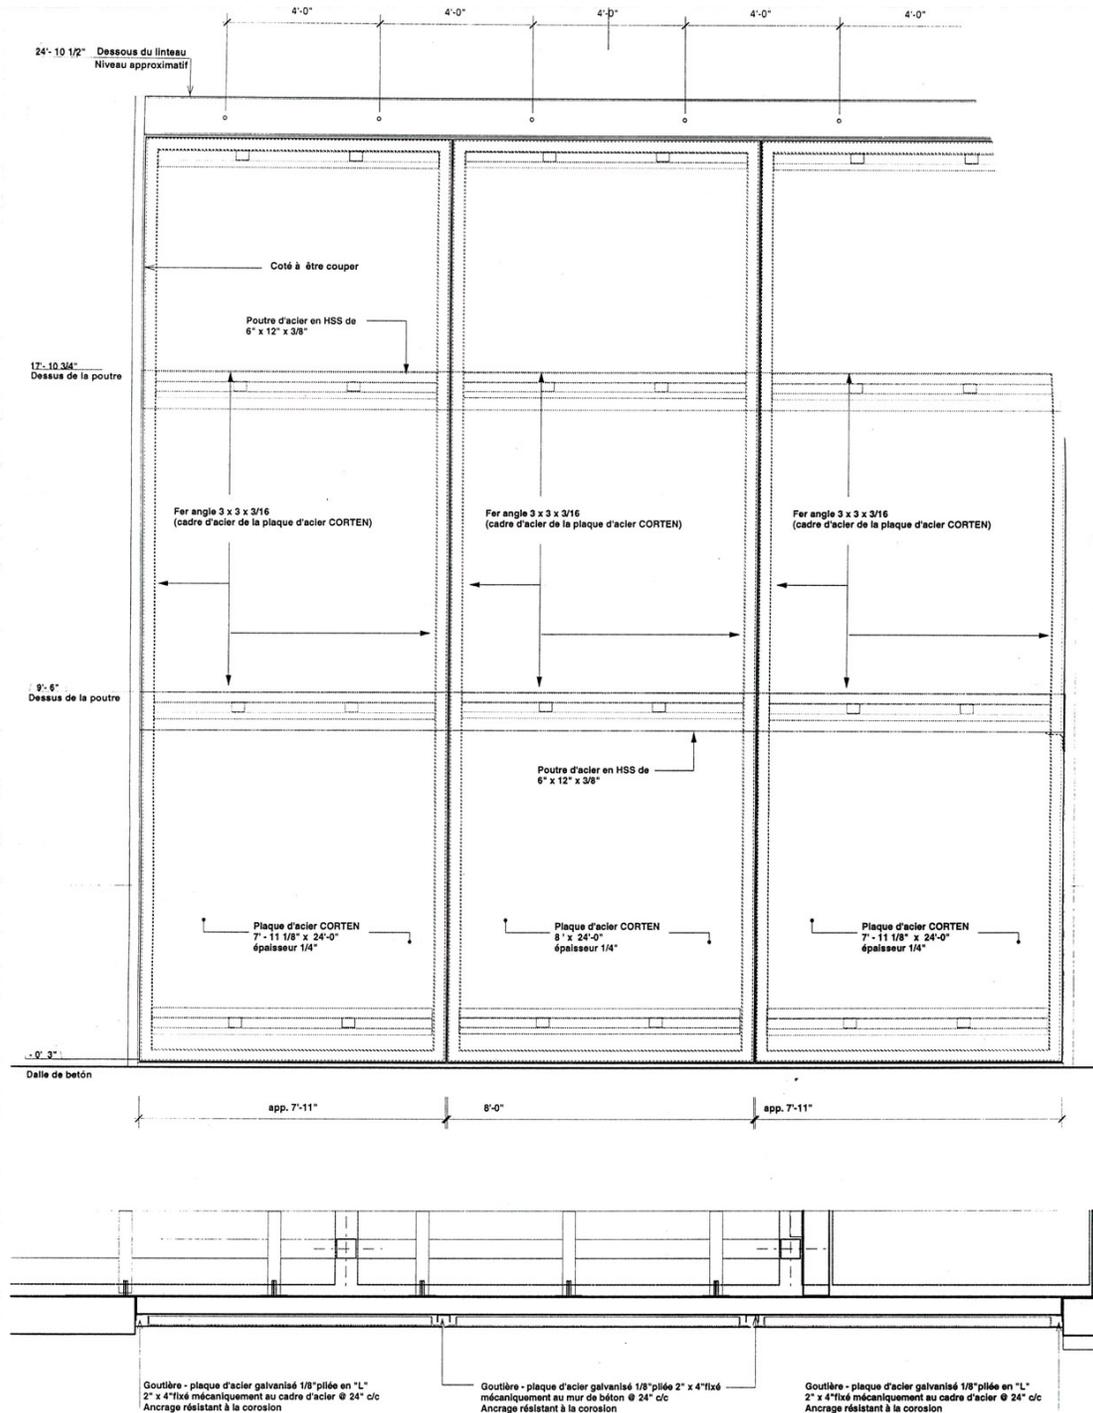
Détail en coupe des panneaux de fermeture (Source : Atelier in situ)
